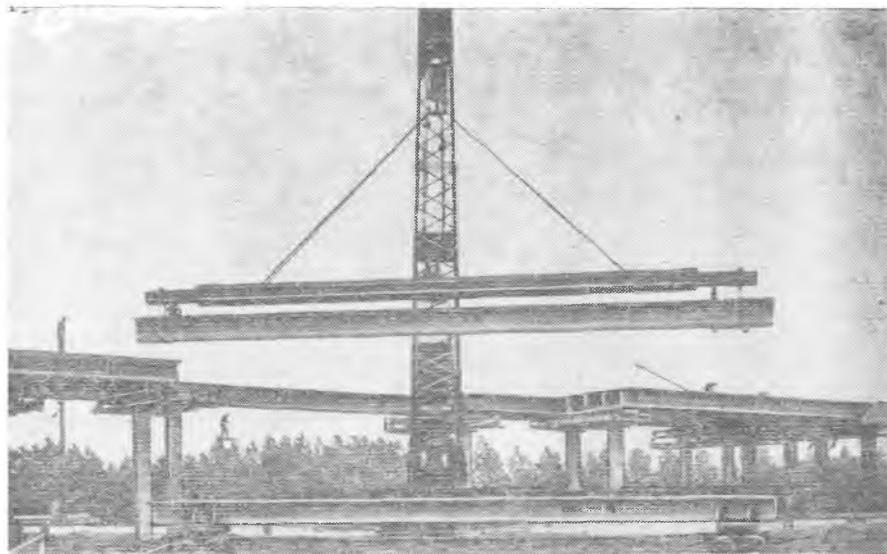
Монтаж пролетных стропильных путепровода с пролетами по 33 при помощи 100-тонного локомотивного крана
